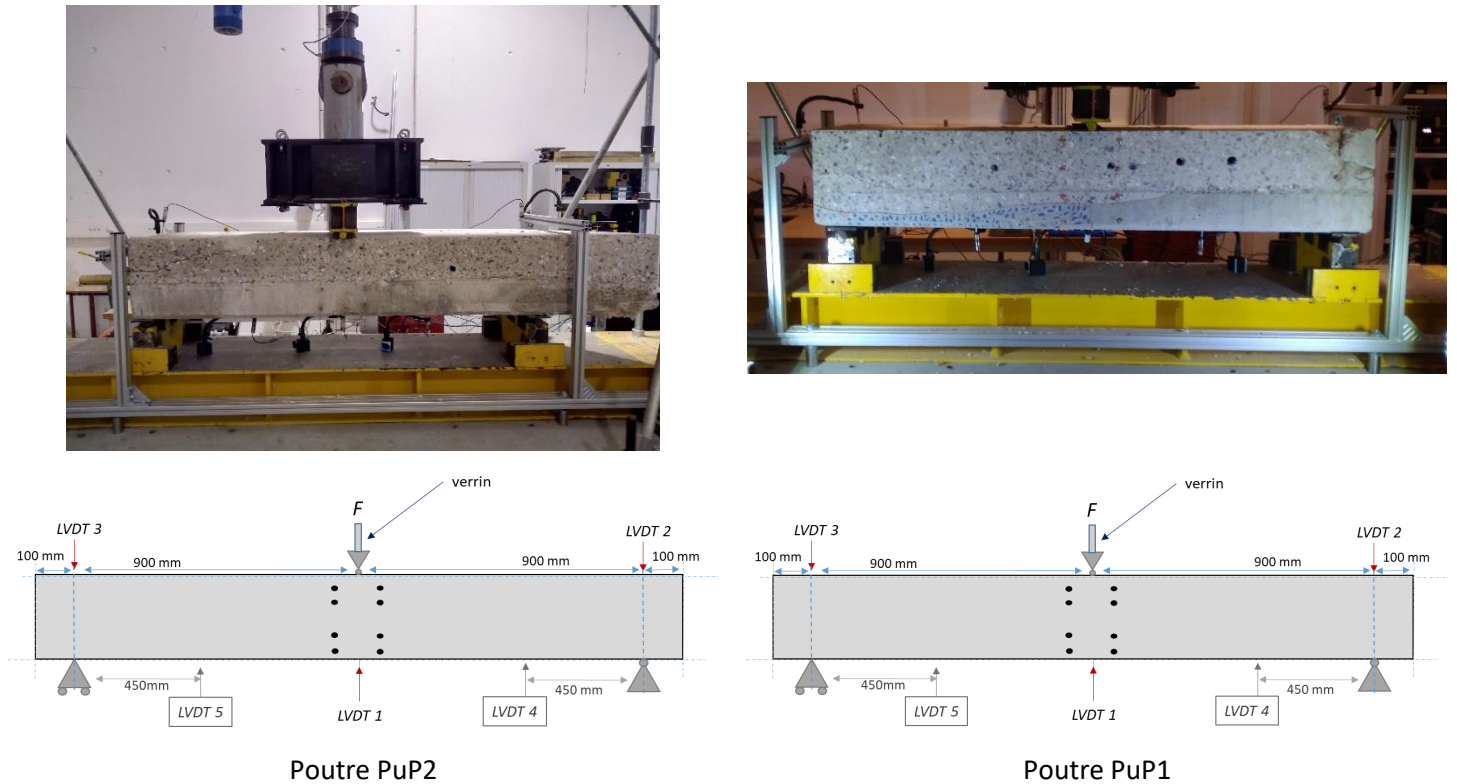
Poutres PuP2 et PuP1 installées et instrumentées au laboratoire Navier, ENPC
